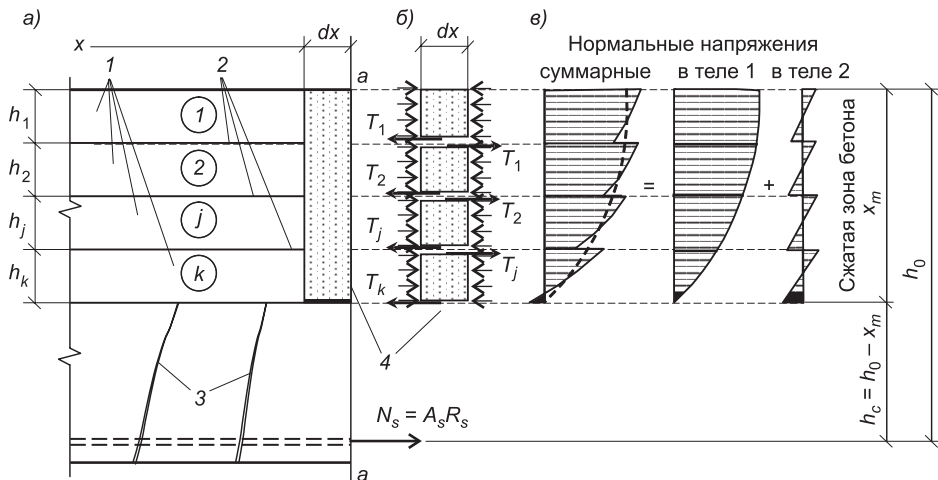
Расчетная схема и напряжения в области наибольших изгибающих моментов в балке a — фрагмент арочной модели арки: 1 — арки; 2 — контактные поверхности слоев; 3 — трещины; 4 — М-образец; б — послойно-элементная модель М-образца; в — эпюры напряжений в сжатой зоне бетона
